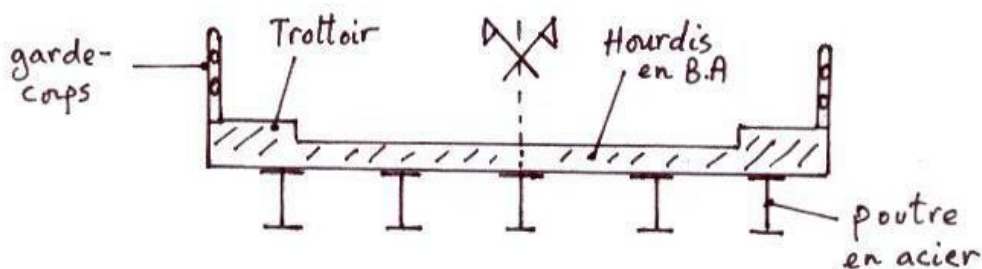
Coupe transversale du tablier d'un pont mixte (acier-béton).
